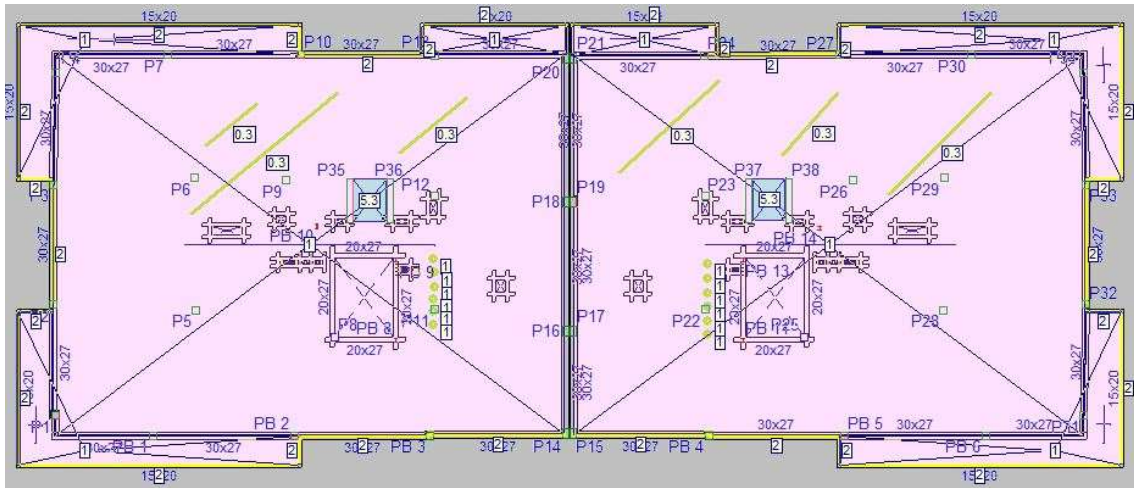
Detalle de cargas aplicadas en planta cubierta
